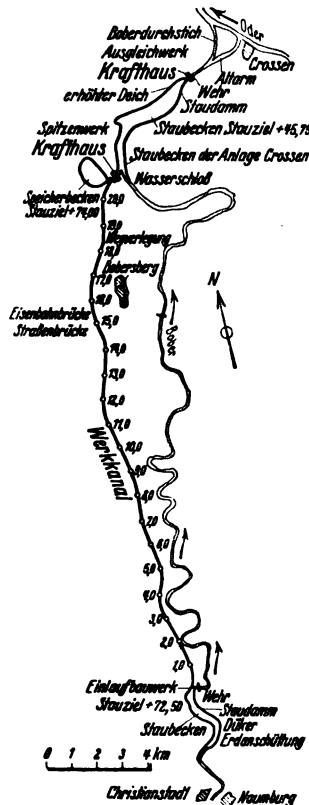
Lageplan der MEW-Wasserkraftanlage am Bober.
